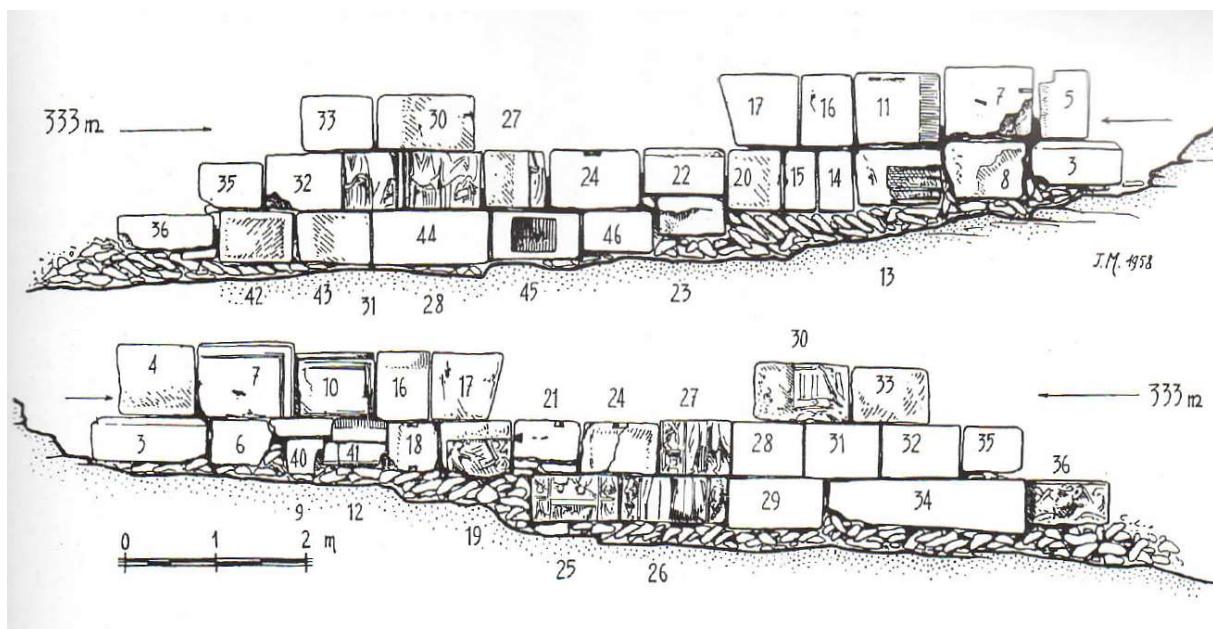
Relevé des faces est (en haut) et ouest (en bas) du mur de soutènement
